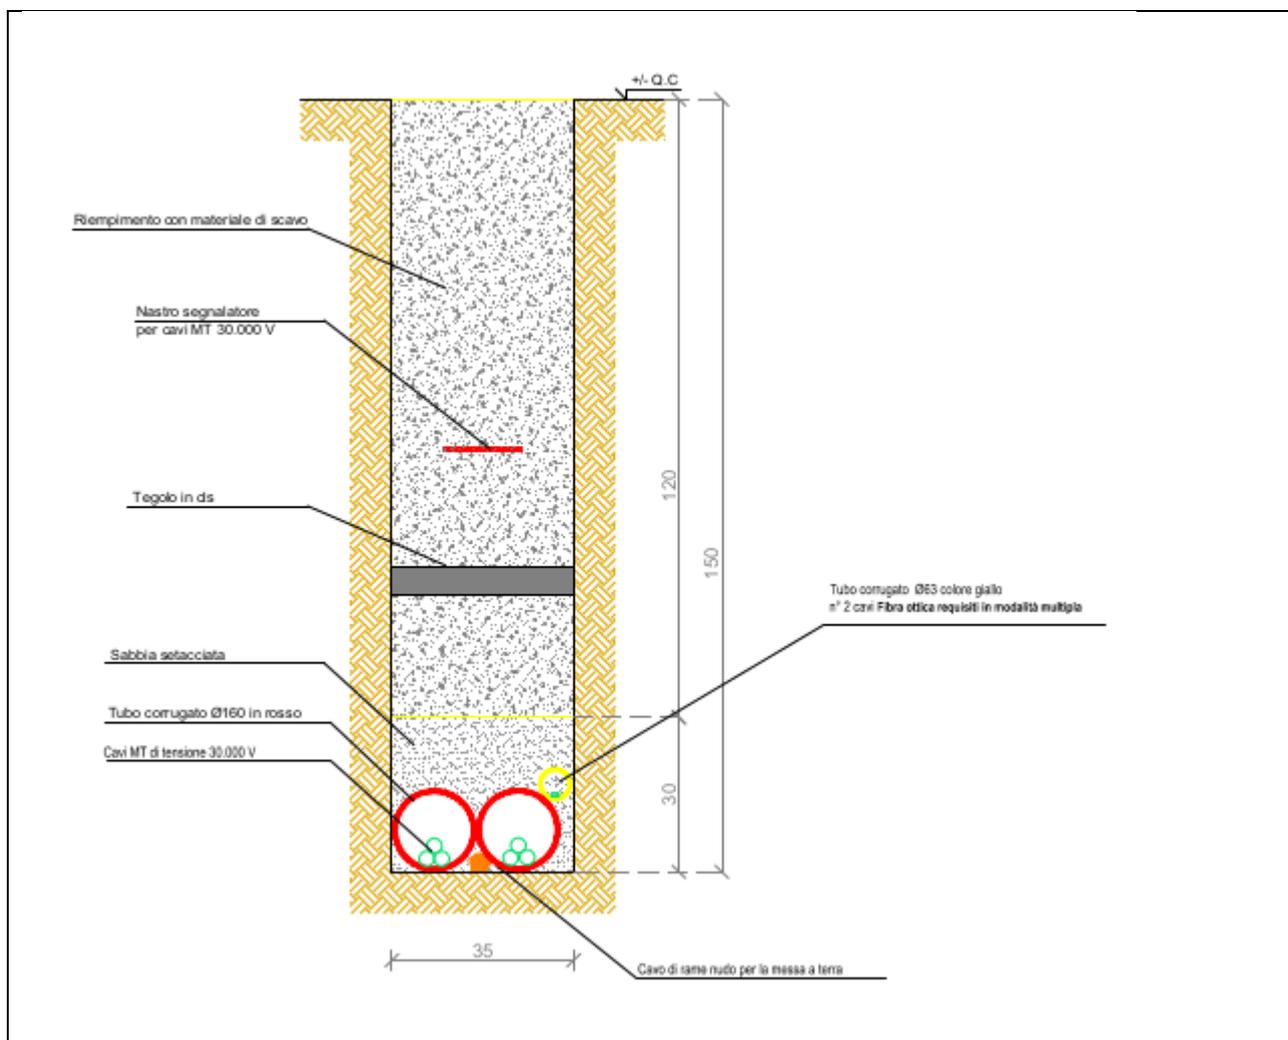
Sezione tipo del cavidotto nel caso di posa in aree a pericolosità idraulica
